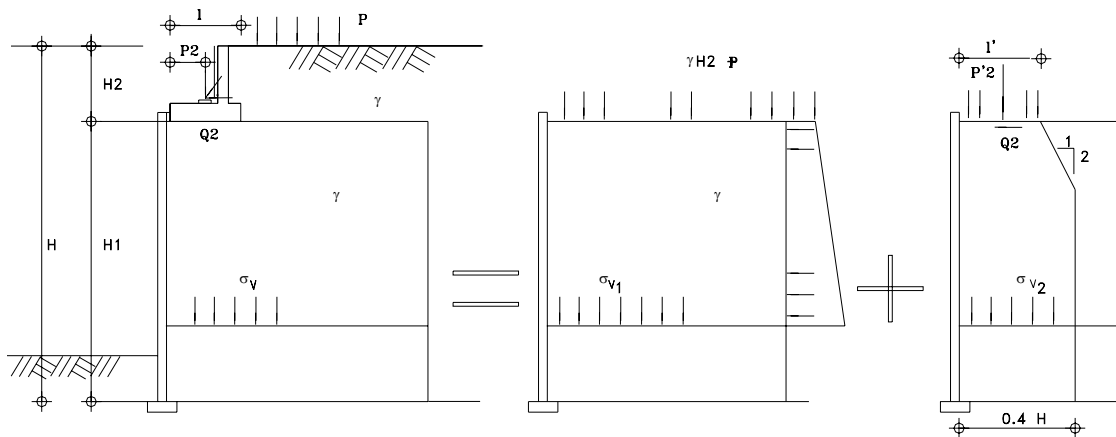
, Cálculo de los esfuerzos verticales en el estribo de un puente
